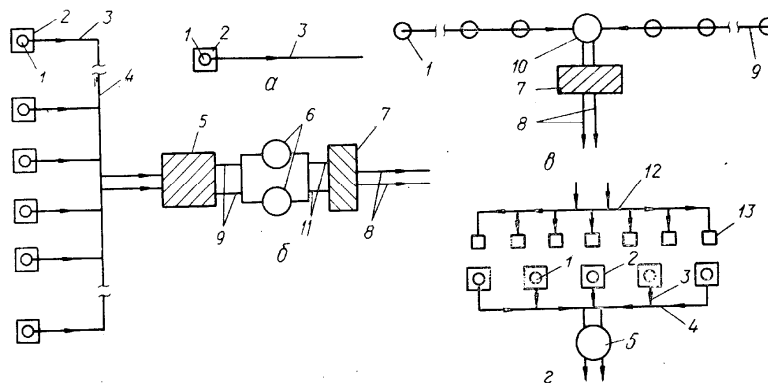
Схеми водозабірних вузлів для приймання підземних вод:
